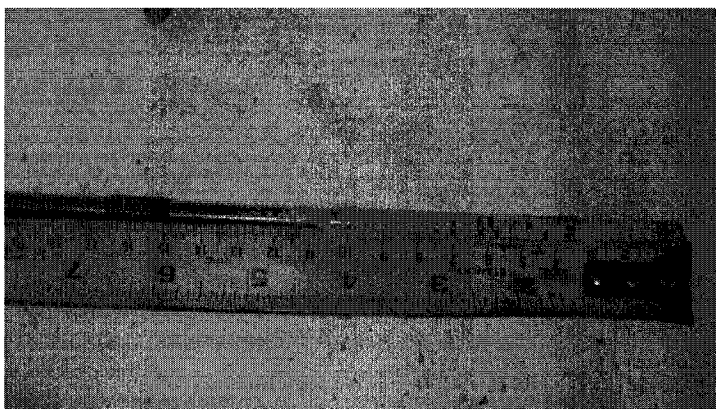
Photo d'une tige d'ancrage cimentaire après l'essai sur une profondeur de 150 mm
